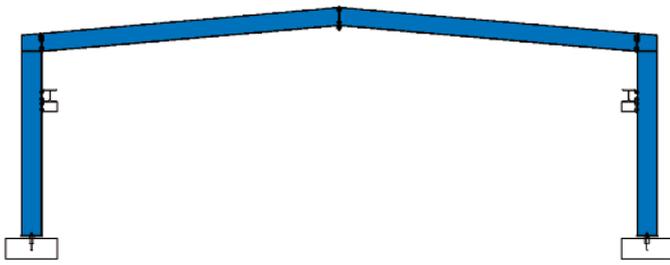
a: Zweigelenrahmen mit nachgiebigen Ecken aus Vollwandprofilen, Spannweite 12,00 m, Typenstatik bauforumstahl,
